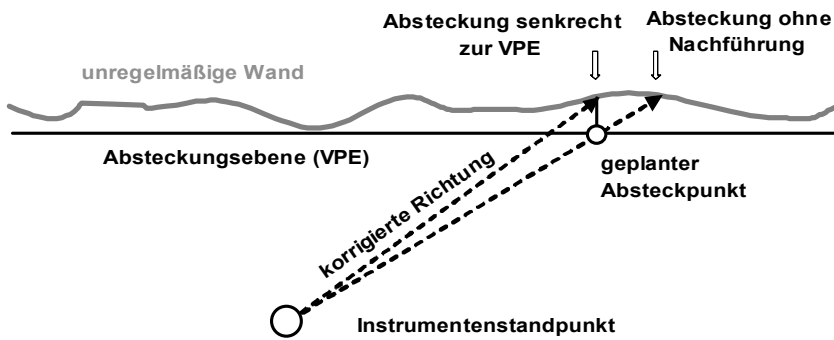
Iterative Absteckung eines Befestigungspunktes (Grundriss)
